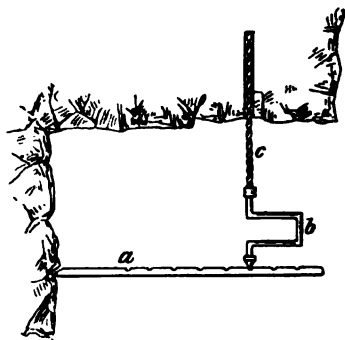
Schlangenbohrer mit Kurbel und Bohreisen.
